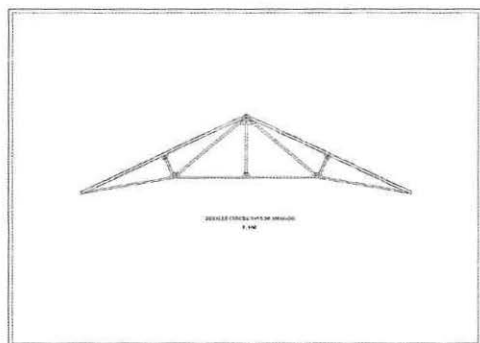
Detalle de la tipo de cercha existente en la nave de amasado.
